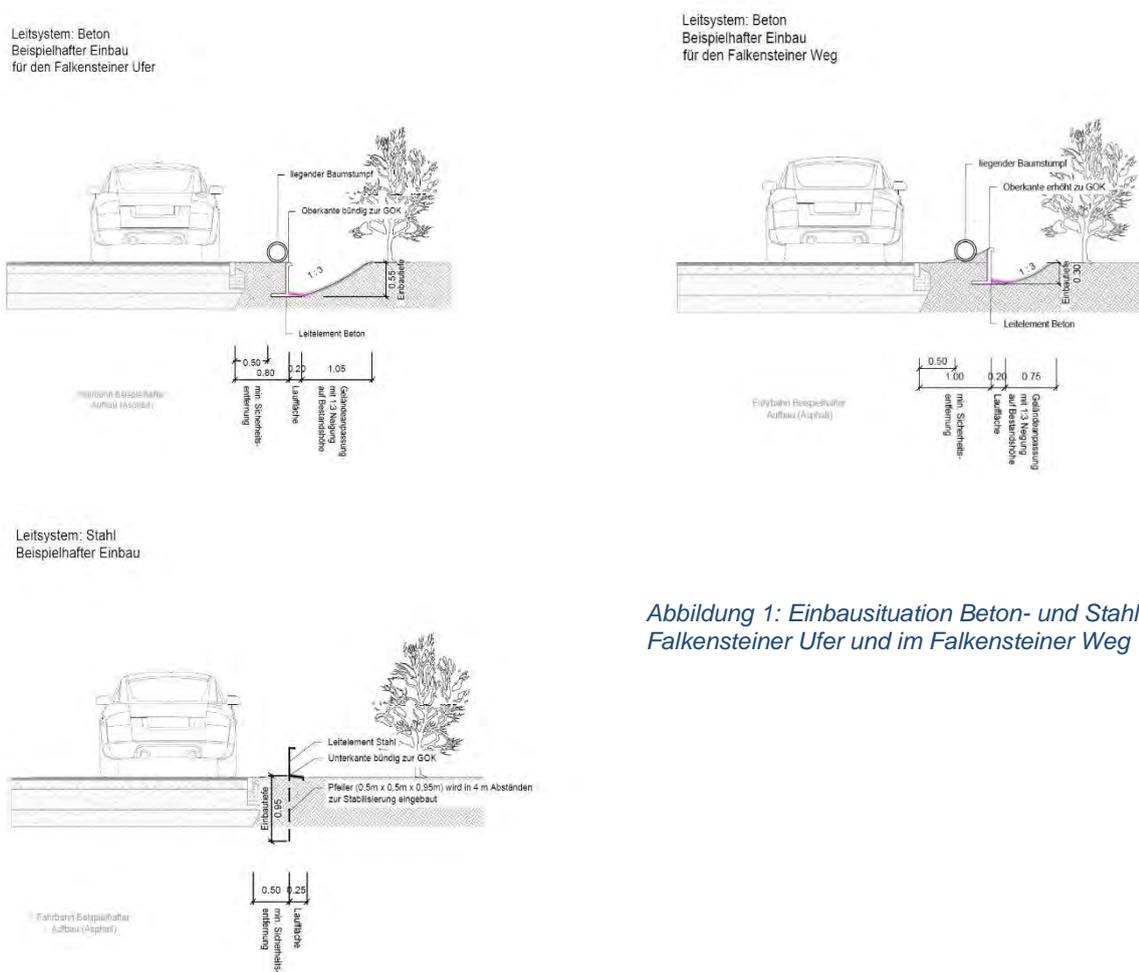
Einbausituation Beton- und Stahlleitelemente im Falkensteiner Ufer und im Falkensteiner Weg
